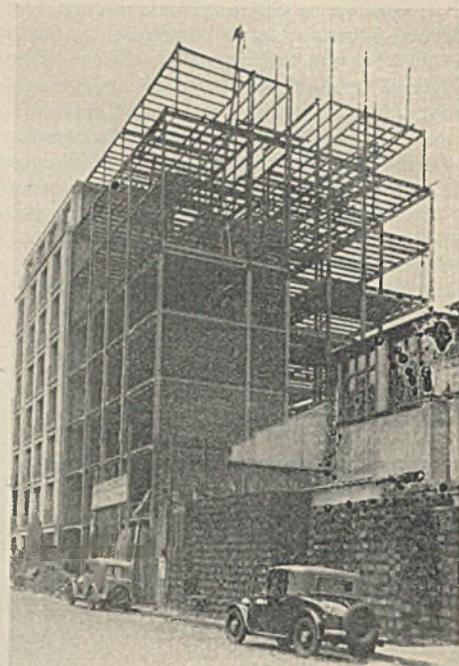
Zehnstöckige Stahlskelettwohnungsbauten in Paris.
